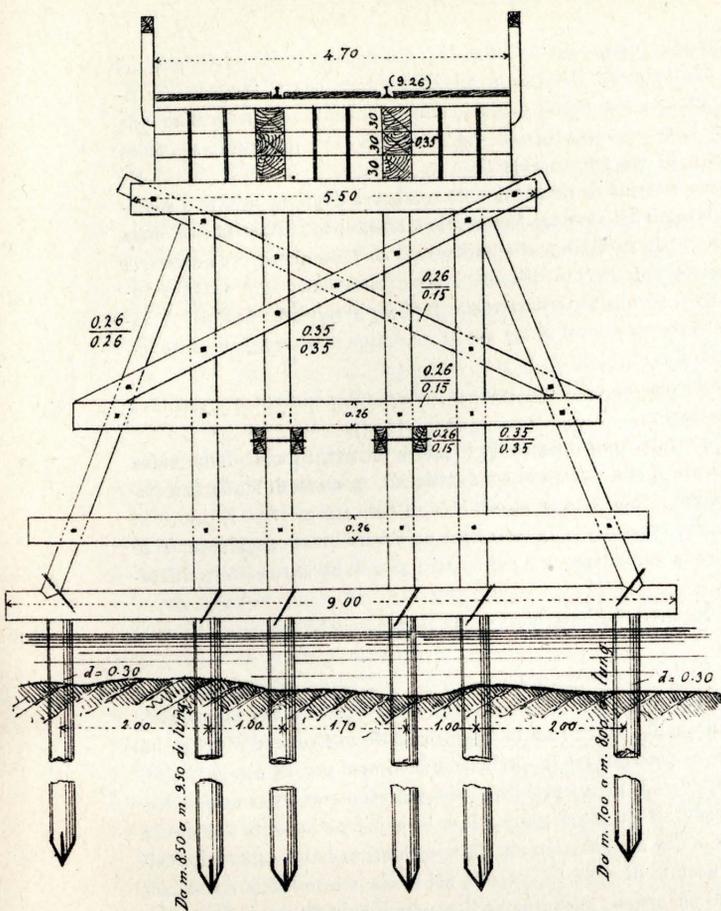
Sezione trasversale. — Scala di 1 a 100.
